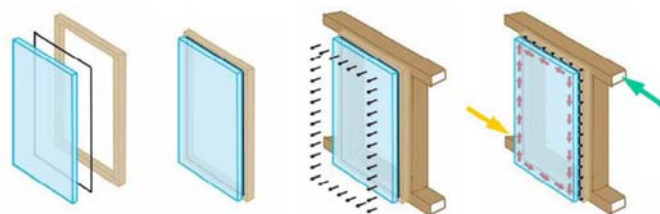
Grundprinzip des Holz-Glas-Verbundelementes zur Gebäudeaussteifung aus [4]
